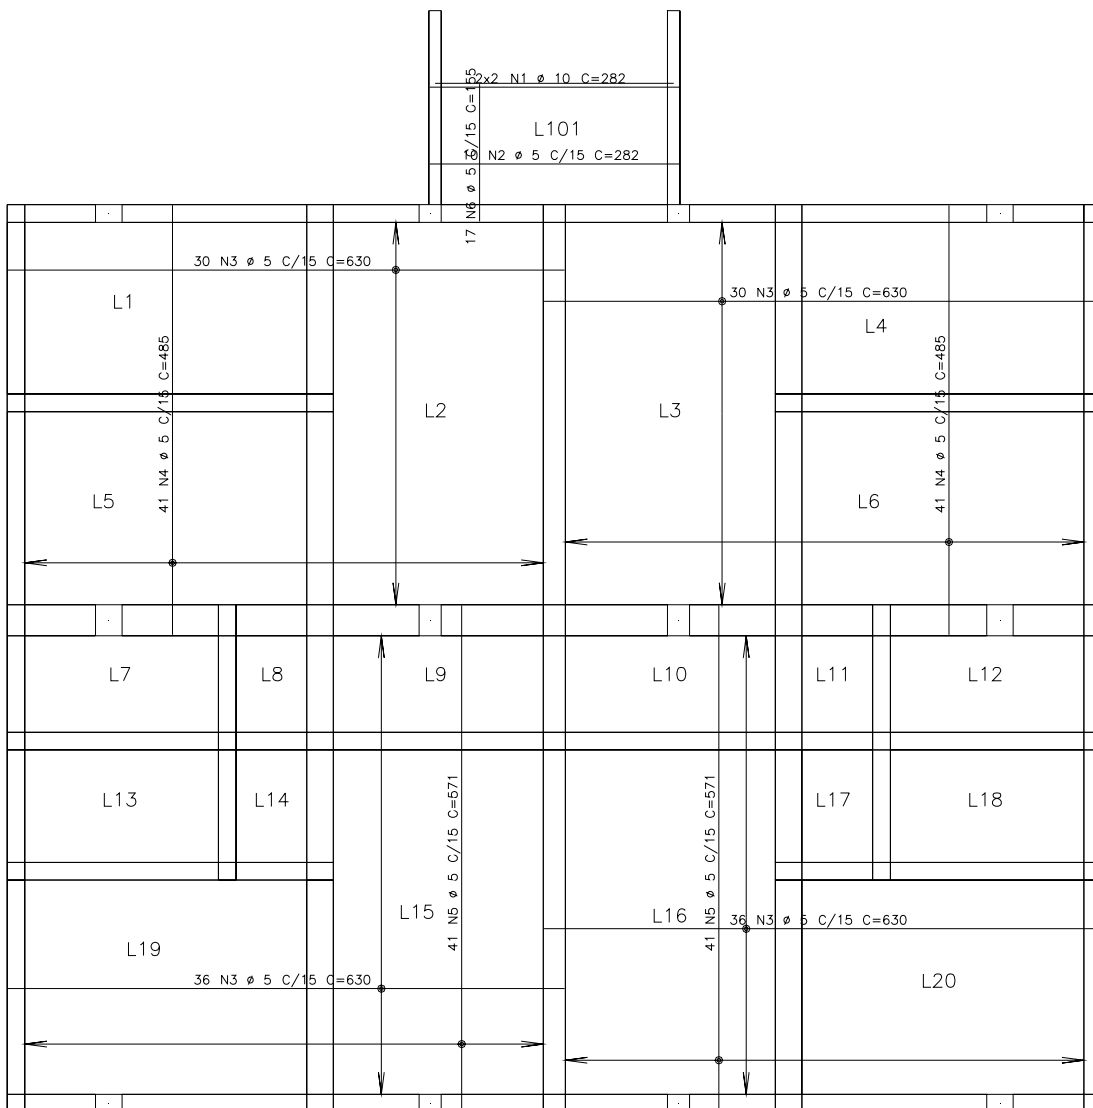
Prédio “C” – Opção 3 – Armação positiva das lajes
